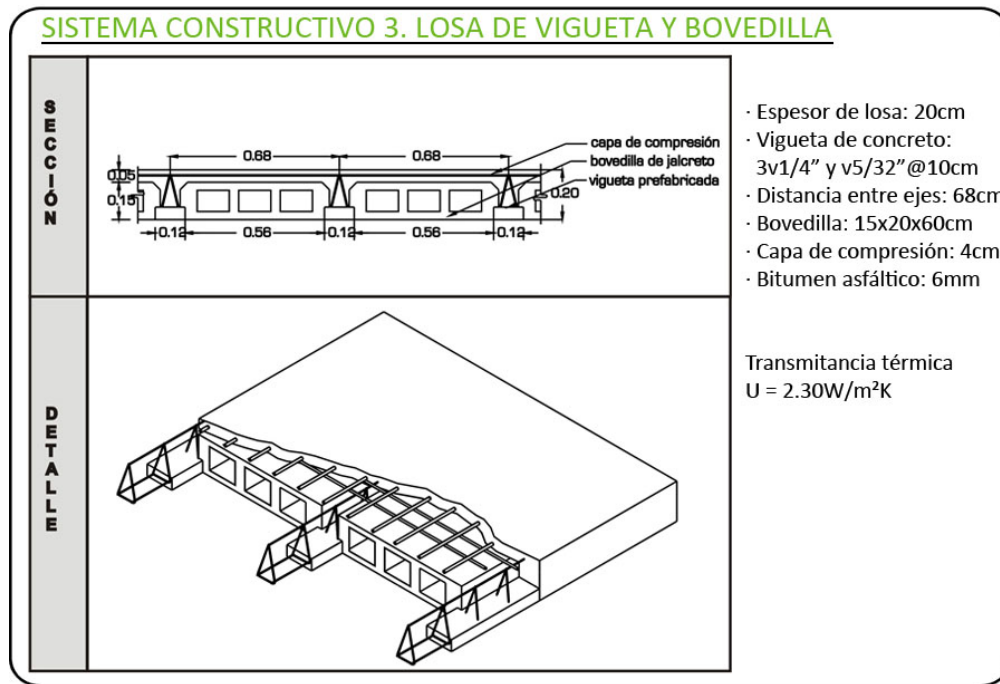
Sistema constructivo para la cubierta de la vivienda de interés social en México.
